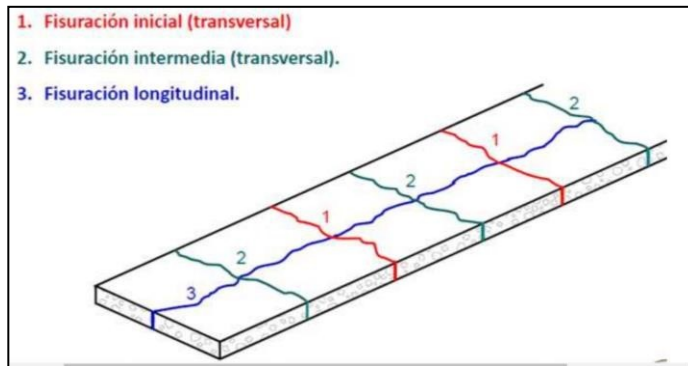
Desarrollo natural de fisuras de Pavimento Rígido
